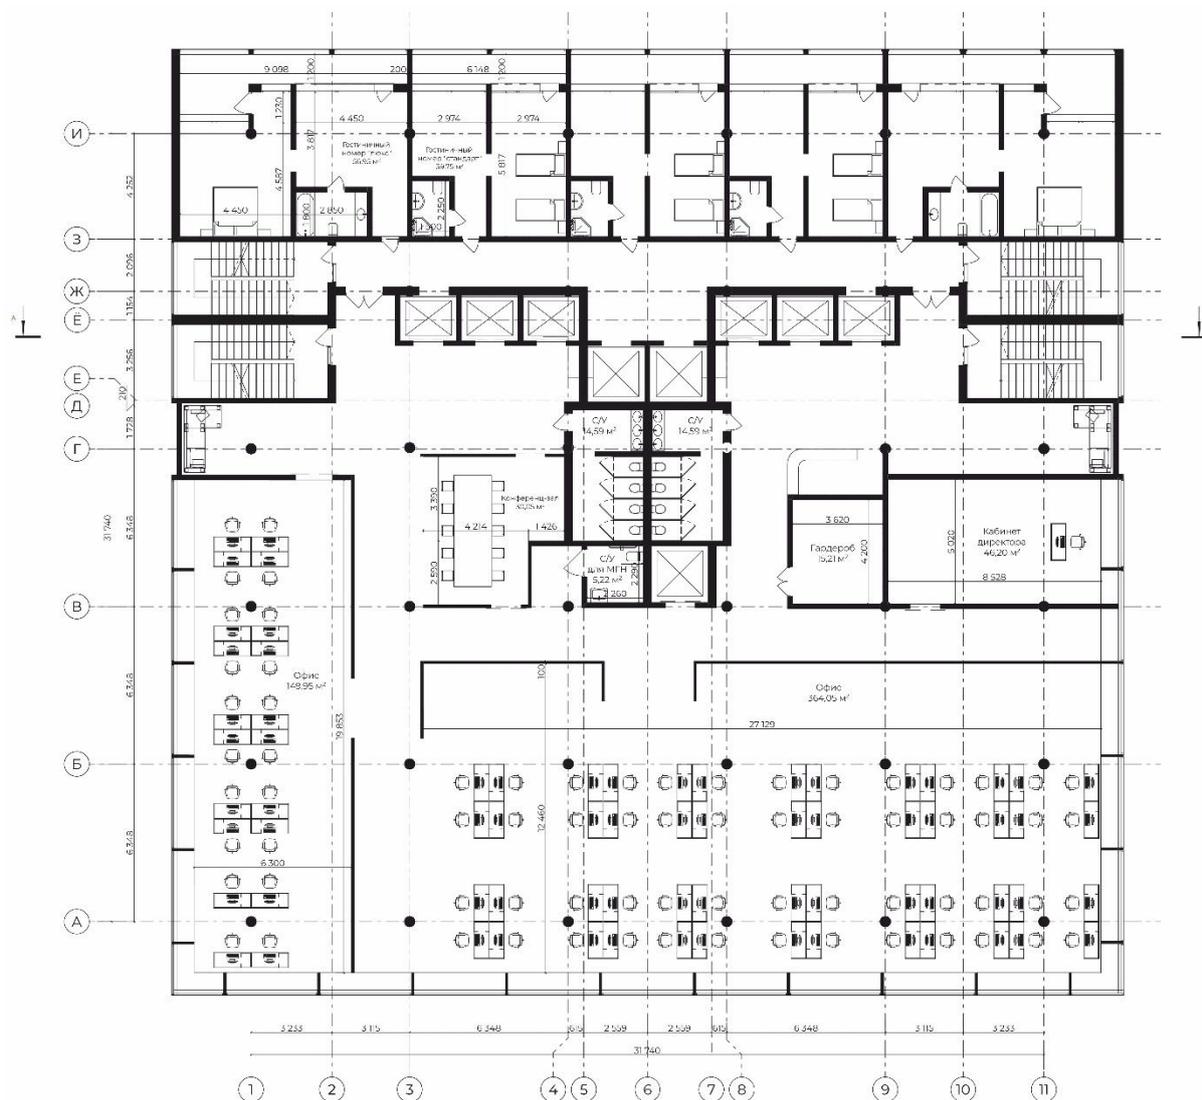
План типового этажа (3-19 этаж, 22-27 этаж)
